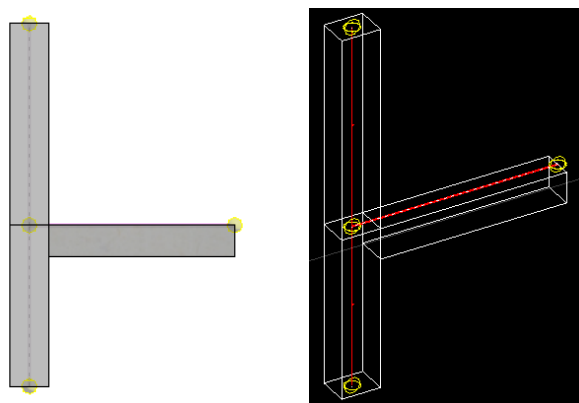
Vistas em alçado e em perspectiva do encontro entre uma viga e dois pilares
